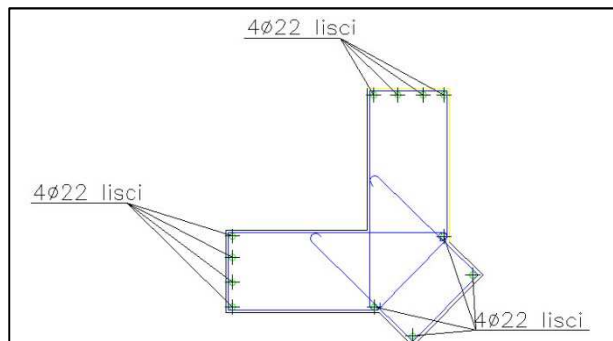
rappresentazione grafica delle armature longitudinali dei pilastri.
